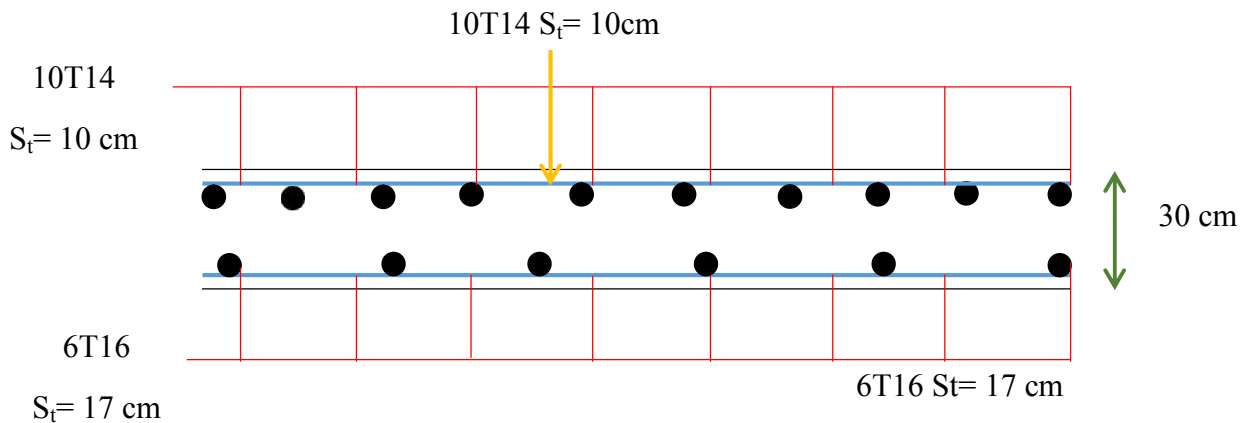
Ferrailage de la dalle du radier en BHP pour une bande de 1m.
